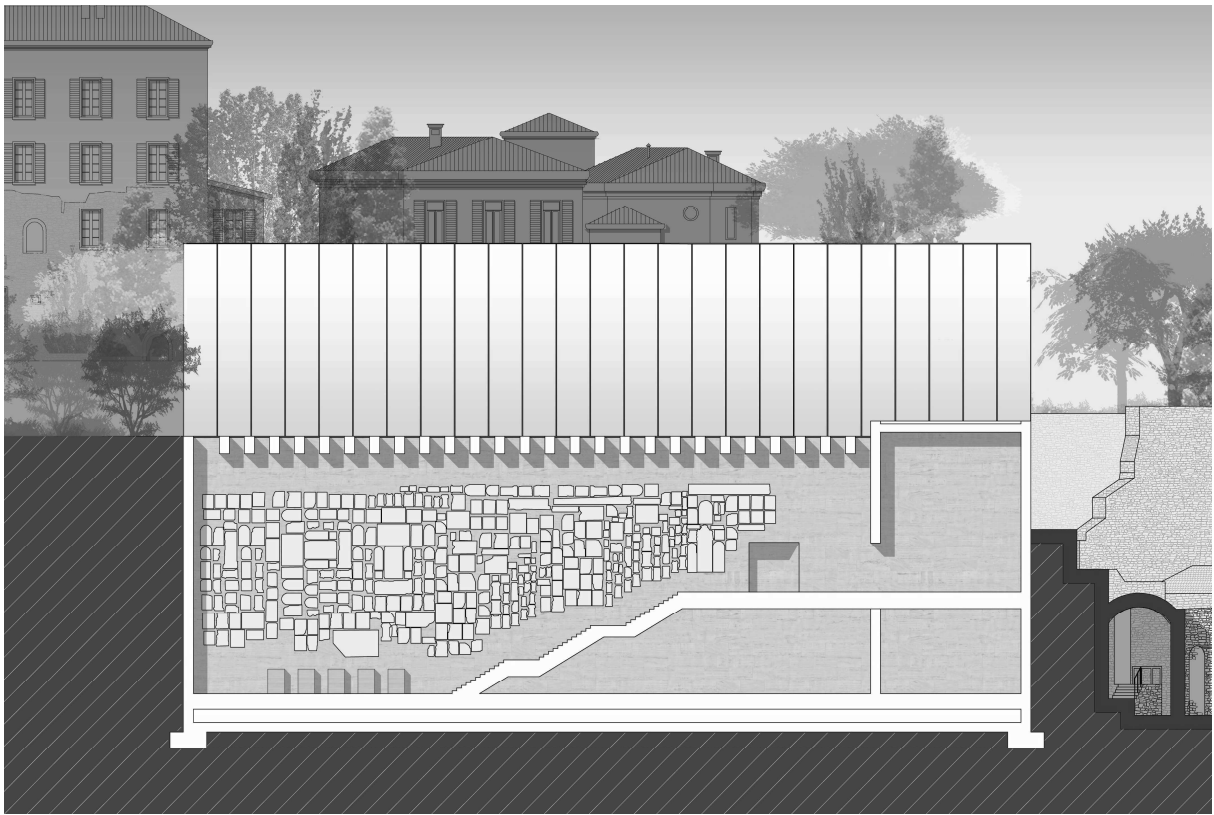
Sezione delle gallerie alle spalle del Capitolium e prospetto dell’edificio di progetto.
